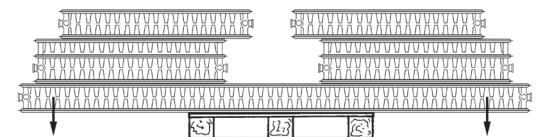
Falsche Lagerung führt zu Beschädigungen
